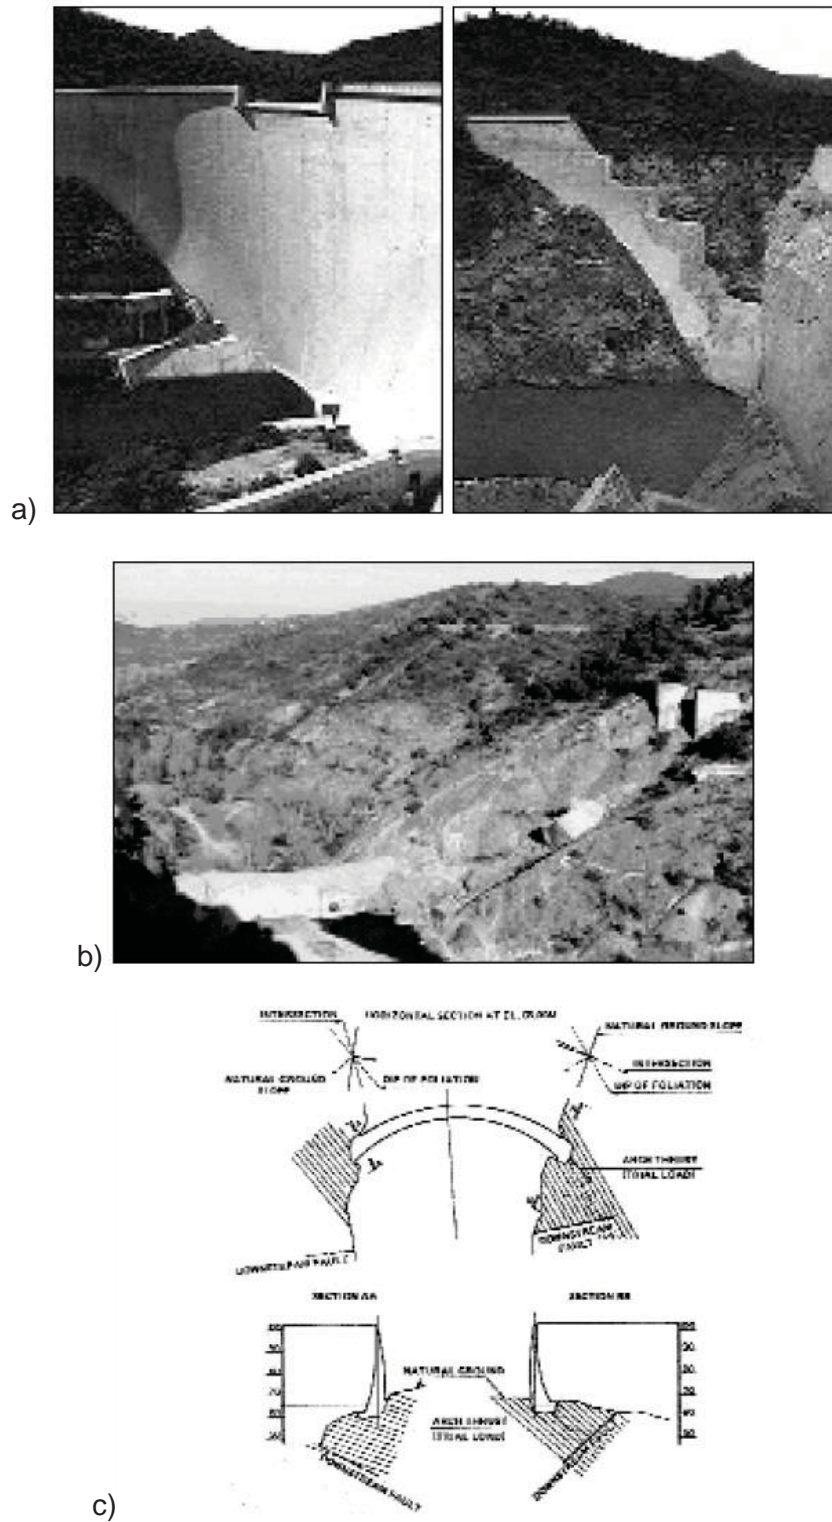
30 a) La presa de Malpasset recién construida y estribo derecho tras la rotura; b) Estribo izquierdo de la presa Malpasset tras la rotura y c) Relación de la estructura de Malpasset con dirección de foliación del gneiss de cimentación (Londe, 1987).
